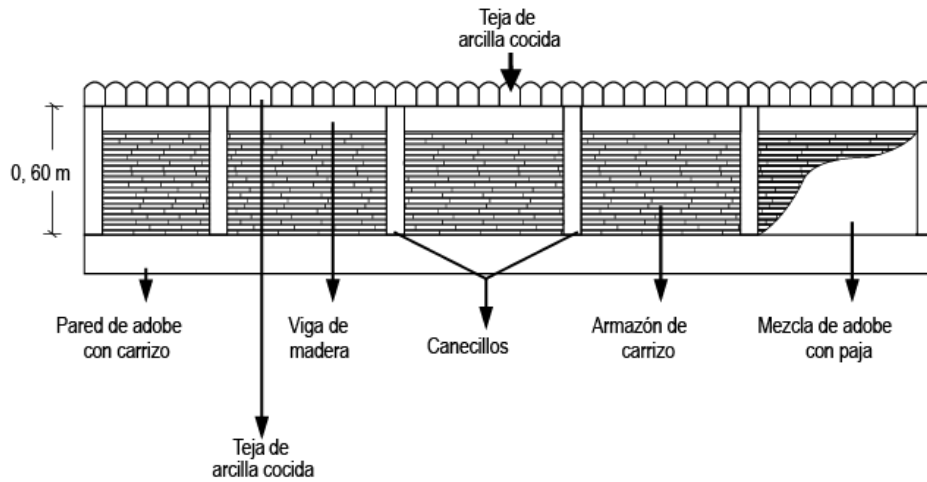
En la ilustración se observa el detalle de construcción de una cubierta típica de las viviendas tradicionales de Tisaleo (mezcla de materiales del lugar y métodos españoles), que son elaborados por carrizo y madera en todo el armazón, después recubierto con una mezcla de adobe con paja para enlucirlo y sujeto por canecillos de madera para darle estética a la cubierta y un soporte estructural a todo el elemento arquitectónico. Al final, las tejas de barro cocido descansan en todo el armazón de carrizo, madera, lodo con paja y la pared.
